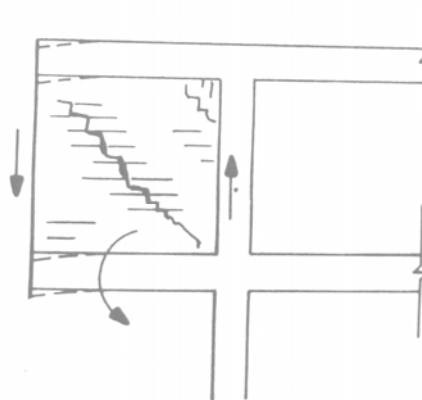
Trincas na alvenaria, provocadas por deflexão da região em balanço da viga. (Fonte: THOMAZ)
